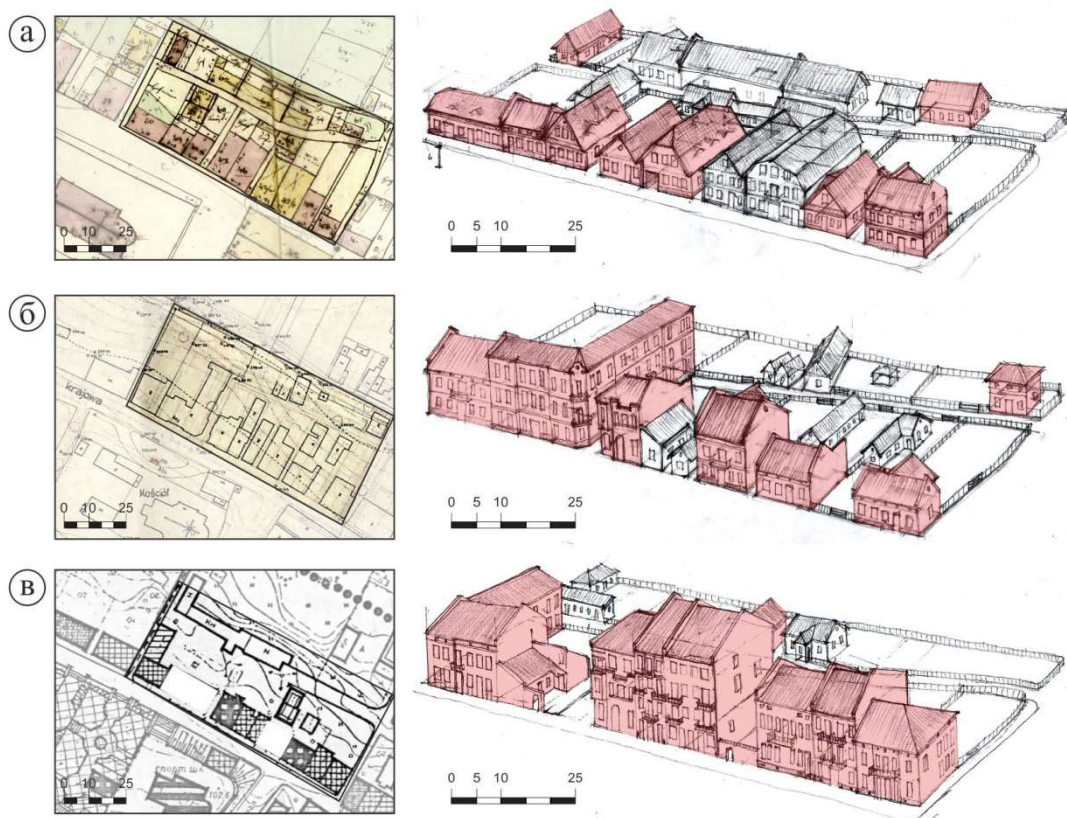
Гіпотетична реконструкція забудови північно-західного кварталу міста Бібрка: а) фрагмент кадастрового плану 1844р., б)фрагмент кадастрового плану 1919 р., в) топогеодезична карта.
